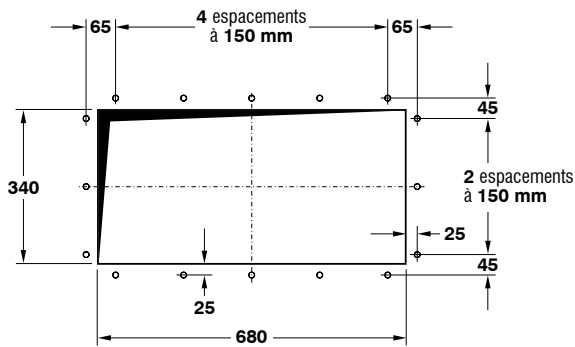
DETAILS DE L'ENTREE D'AIR CONTAMINE POUR
